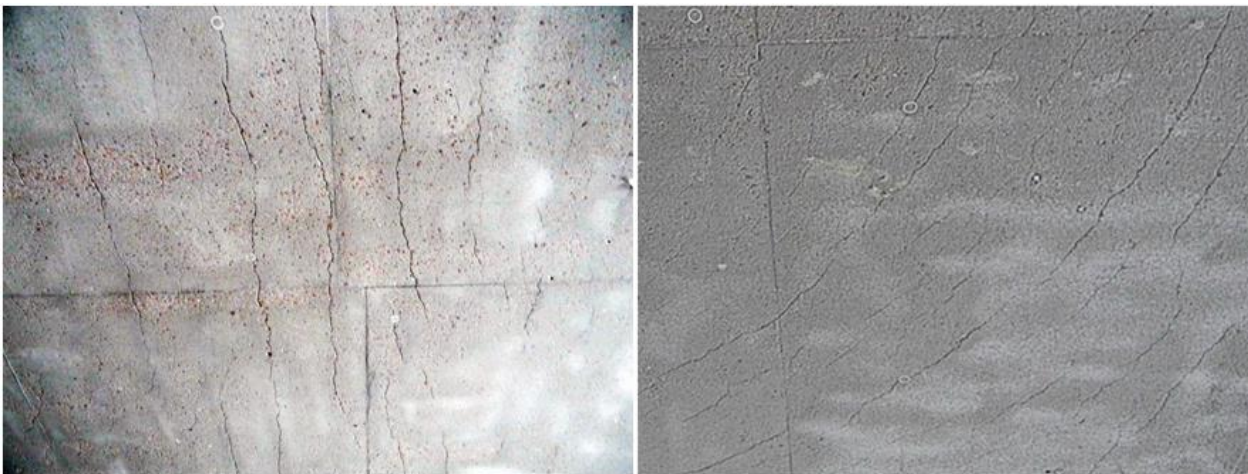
Тріщини в розтягнутій зоні залізобетонних плит перекриття
